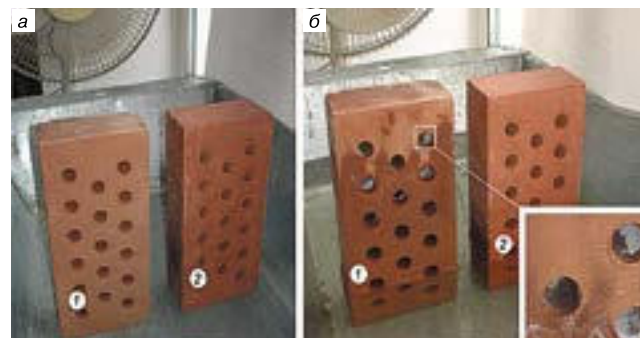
Испытание керамического кирпича из шламистых железорудных отходов (1) и отходов углеобогащения (2) на образование высолов: а — внешний вид до испытаний; б — то же после испытаний
